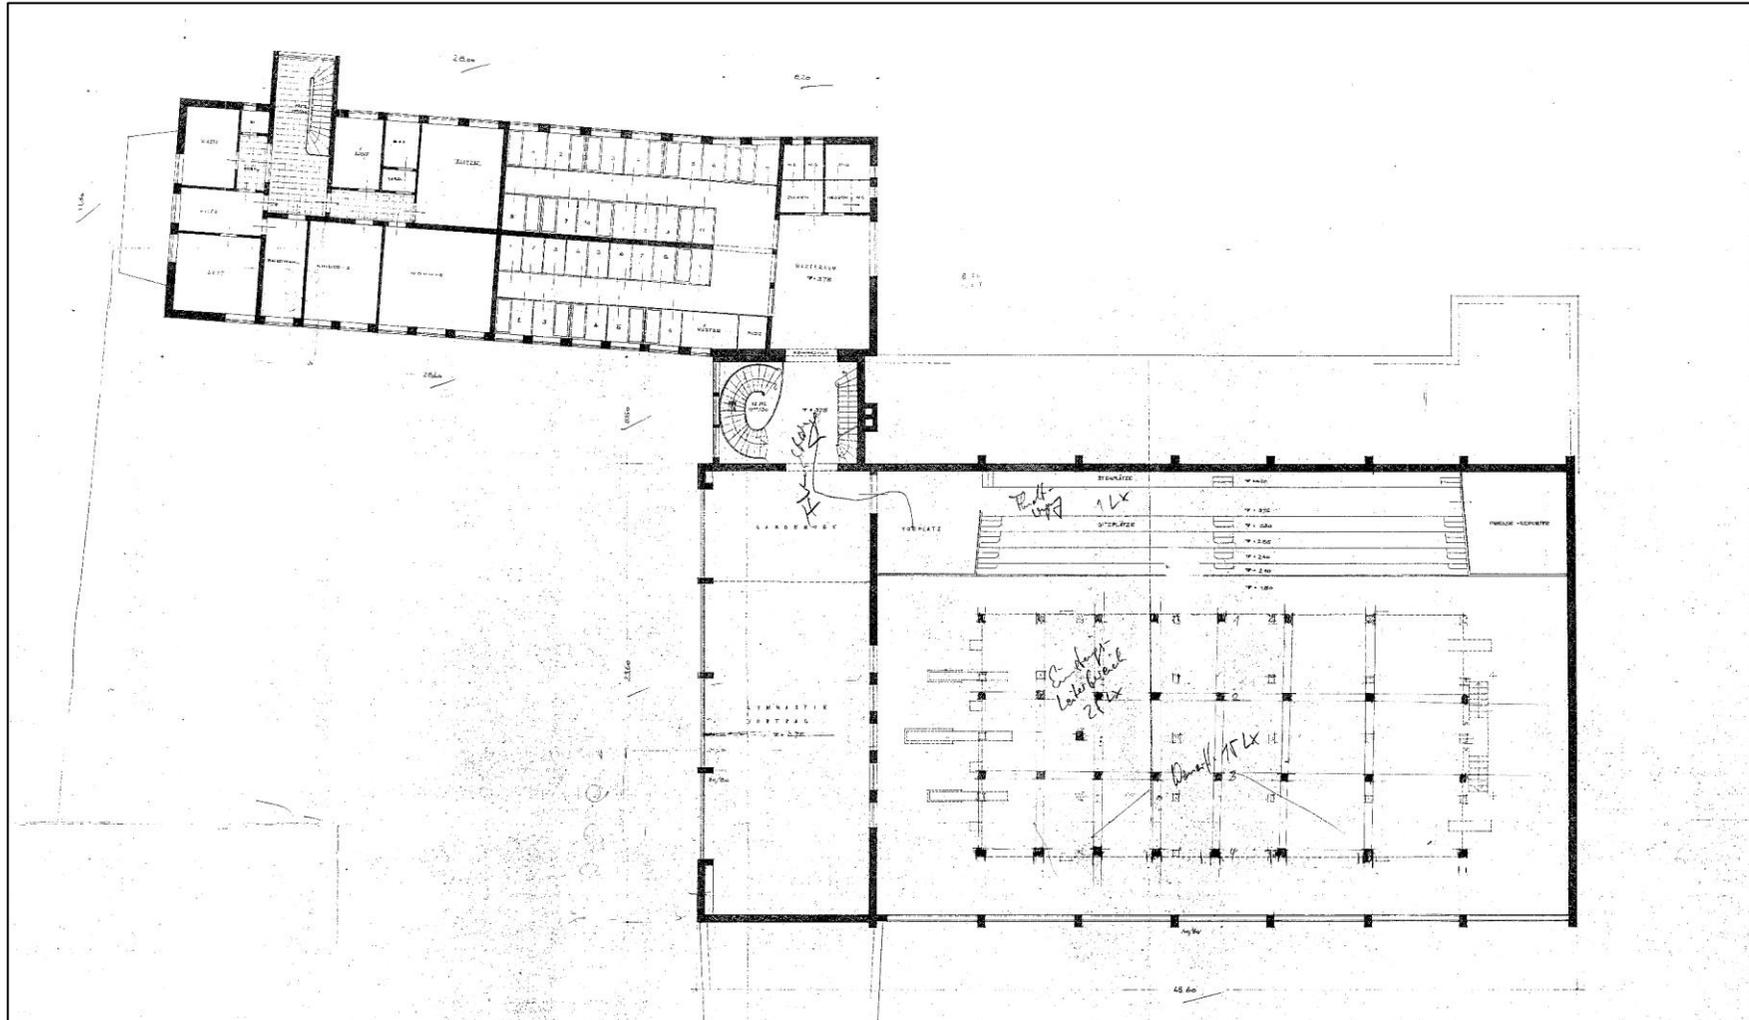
Lageplan des ehemaligen Hallenbads
